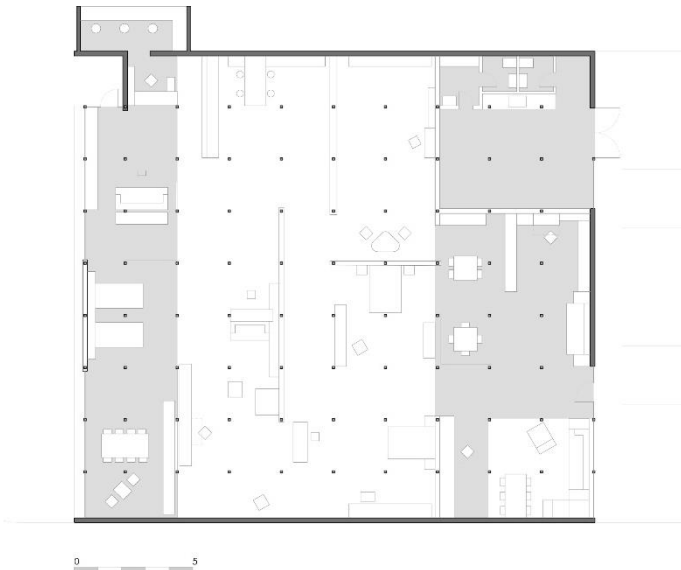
Plano de planta baja del *Herman Miller Furniture showroom* redibujado
